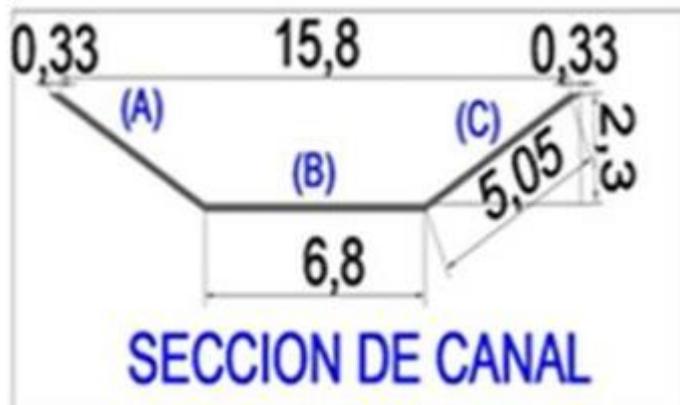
Sección transversal de canal trapezoidal Biaggio Arbulú
